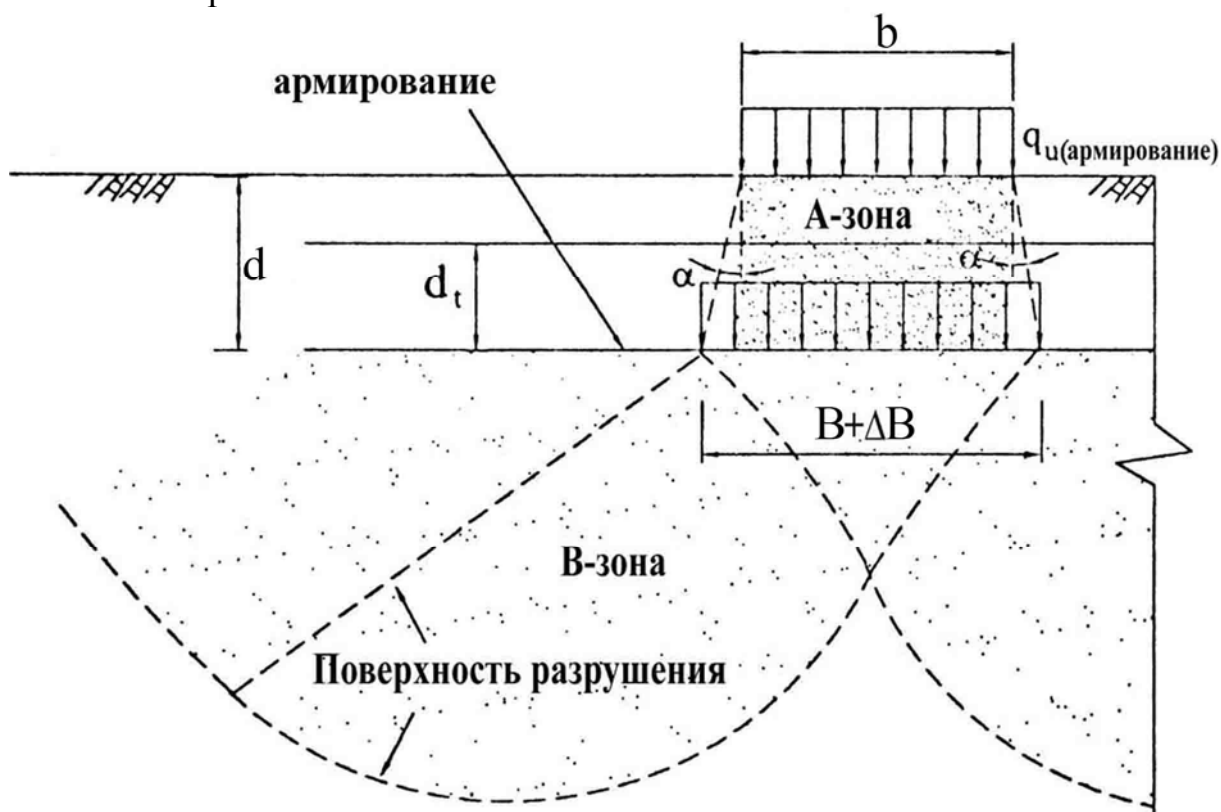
Схематический вид механизма разрушения армированного основания, где α – угол уширения; b – ширина ленточного или прямоугольного фундамента; d_t – глубина армированной зоны; d – глубина заложения нижнего слоя армирования; q_u – предельная несущая способность армированного грунта
